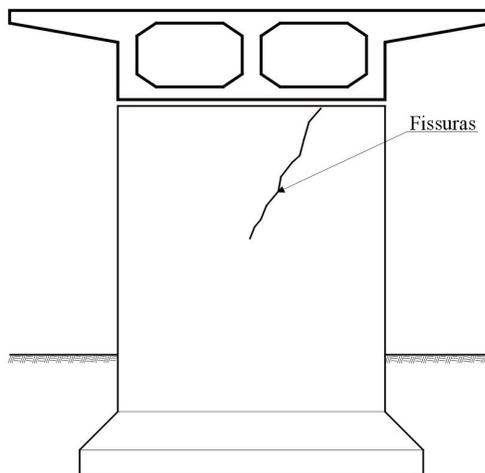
Fissuras em pilares ou encontros provocadas por recalque diferencial
